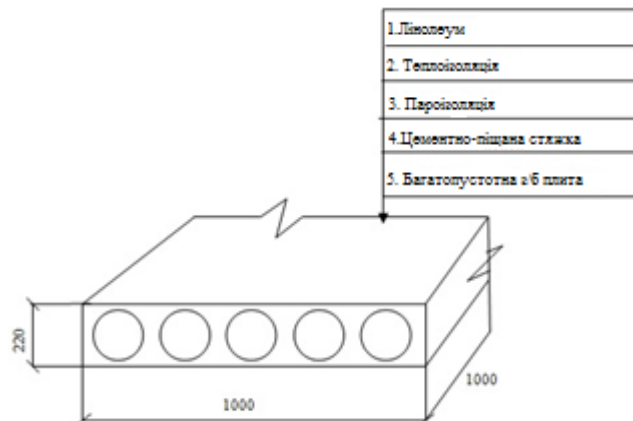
Збір навантаження на 1м² плити перекриття
